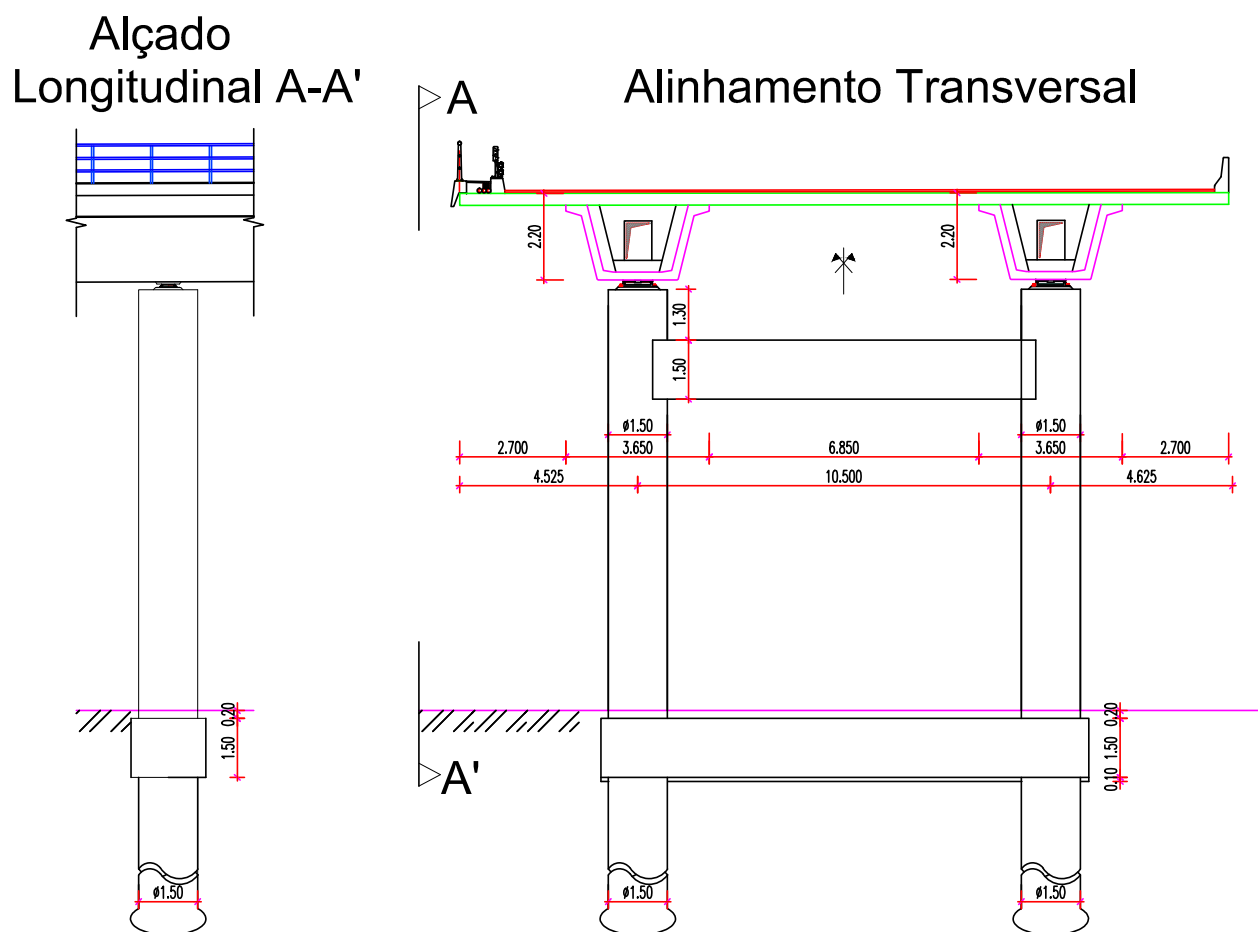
Vistas dos pilares do viaduto e sua geometria (m) [9]
